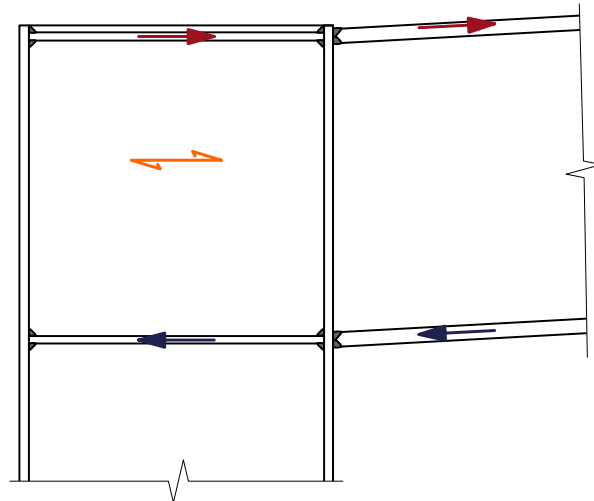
Assemblage soudé de poutre sur poteau
